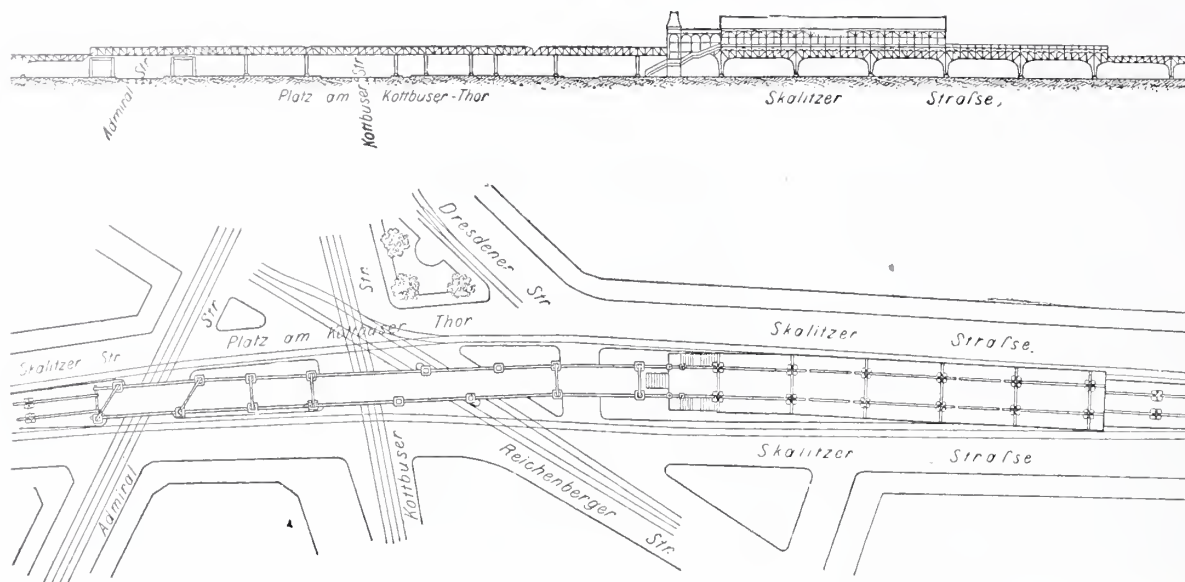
Haltestelle Kottbusertor. — Ansicht und Lageplan. — Masstab 1:1500.
